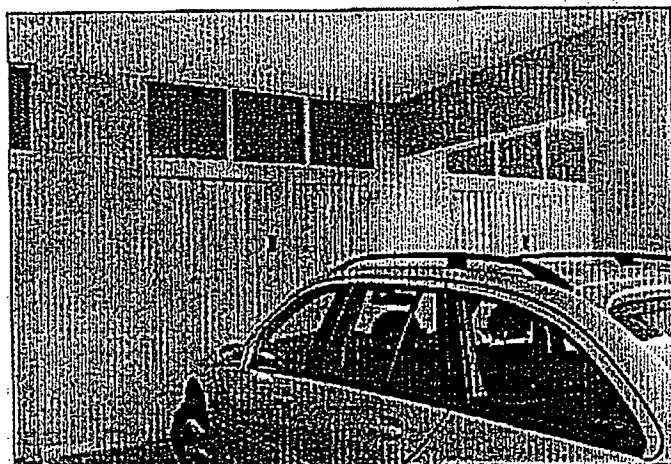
Piano terra Coop. ██████████ di ctr. "Ferrantazzo"
